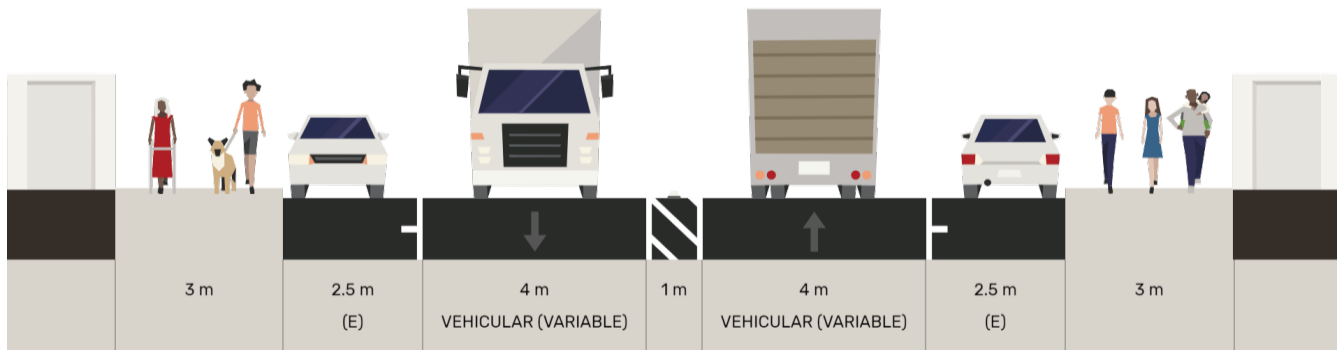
Sección vial propuesta para Calle Monte Alban. Fuente SIGMUN
